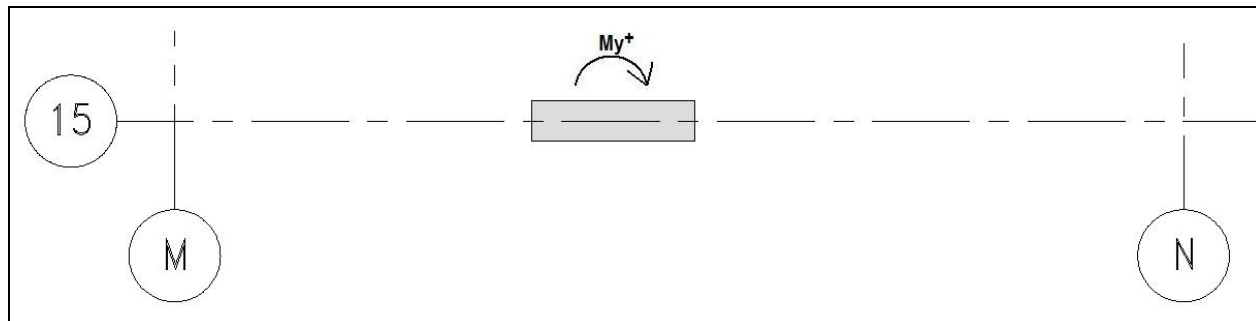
Esquema Muro Eje 1, M-N (2° Piso)
